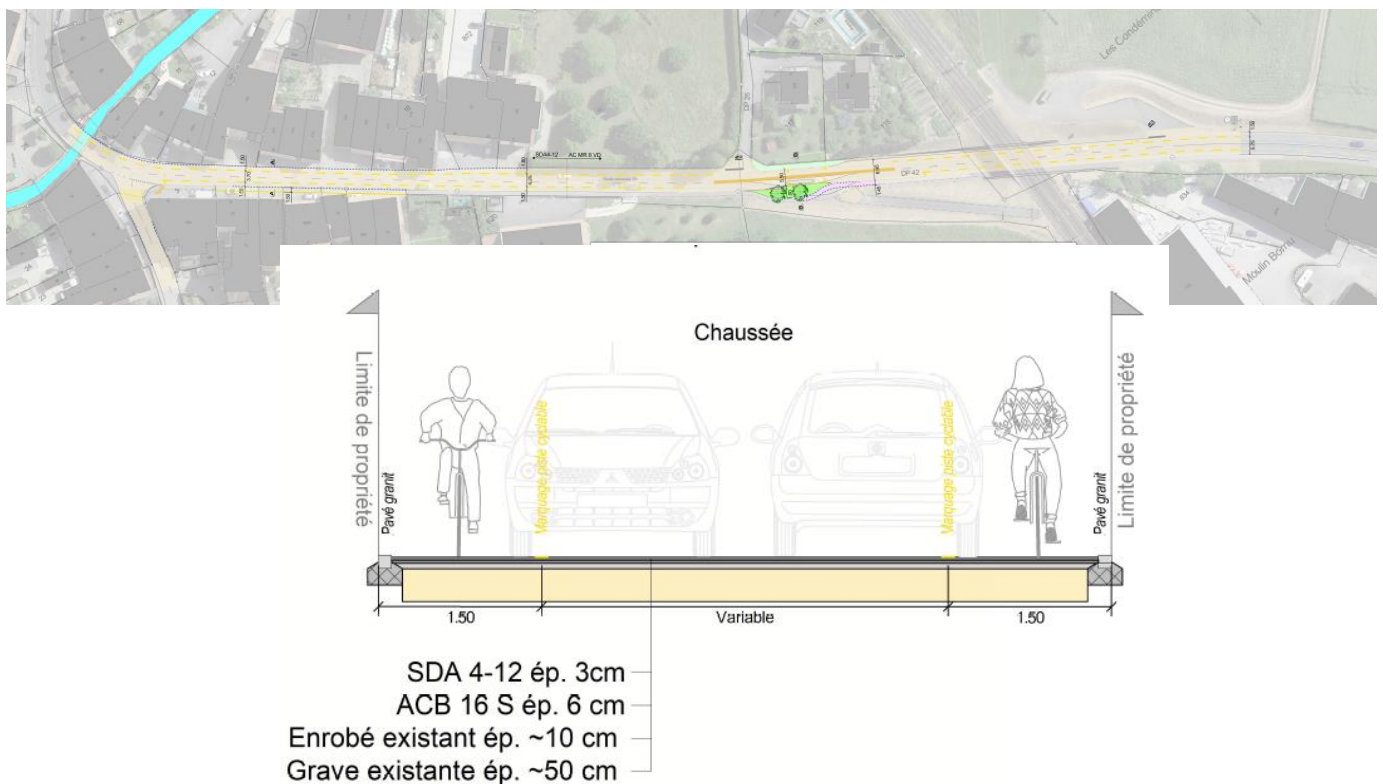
Situation de la réfection de la chaussée et coupe-type
